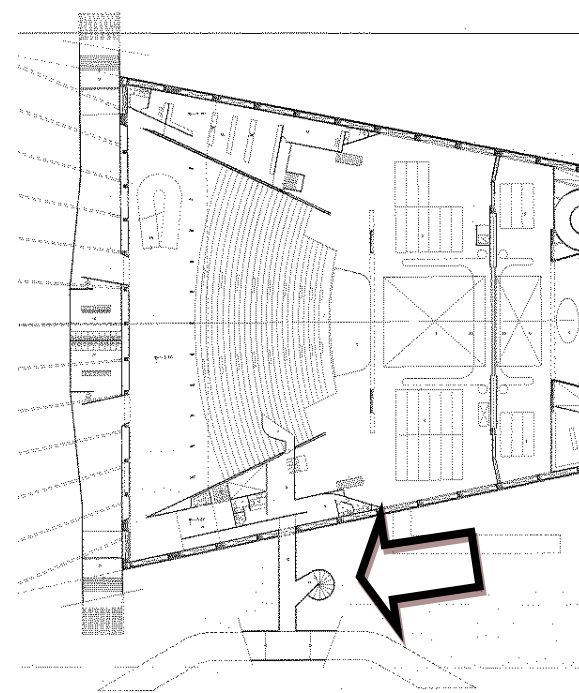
Planta Baixa - Subsolo 1 (1976).
